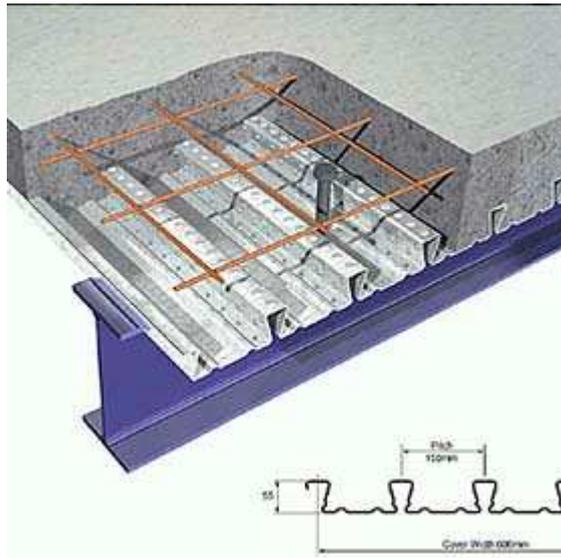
Losa sobre lamina de acero (A fine WordPress.com site, 2013)
